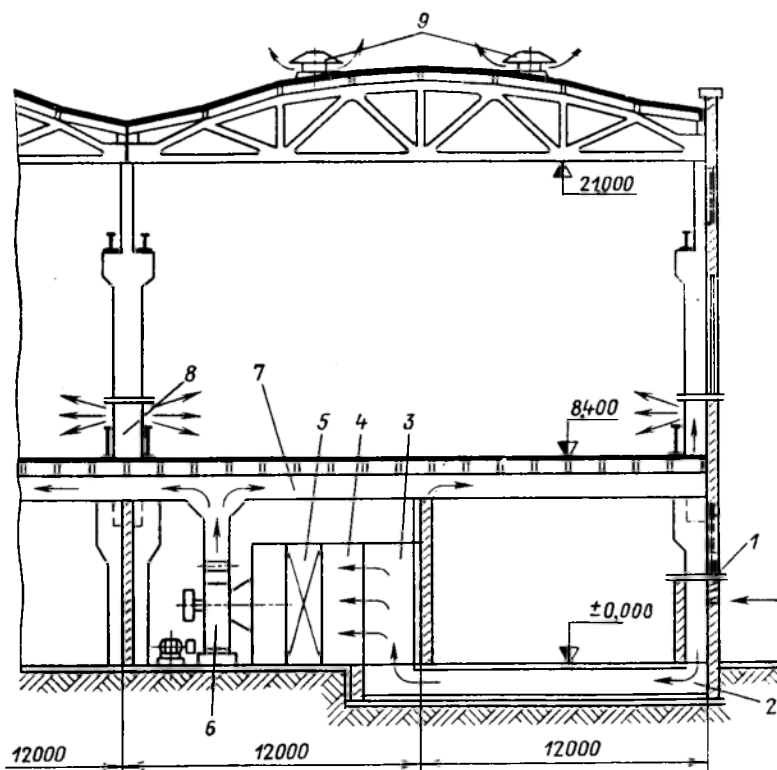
Размещение камеры приточной вентиляции в двухэтажном здании:
